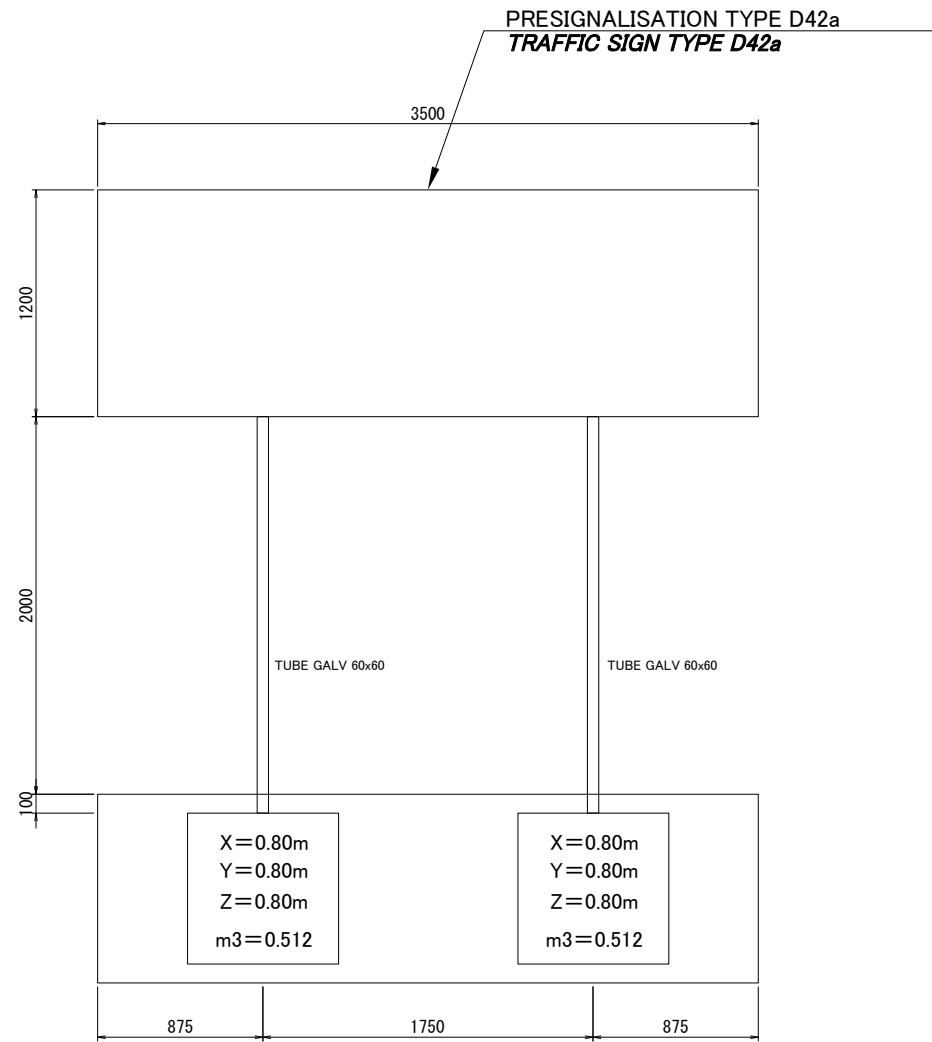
DETAIL DU MASSIF ET DU POTEAU DES PANNEAUX DE DIRECTION (1) DETAIL OF INFORMATORY SIGN BOARD (1)
